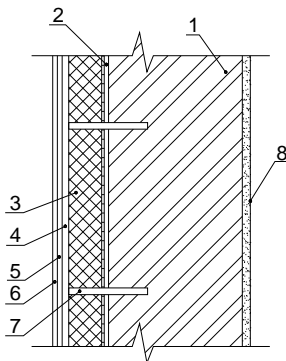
Система утепления фасадов с отделочным слоем из штукатурки 1 – силикатный кирпич; 2 – проникающая грунтовка клеевого состава; 3 – наружное утепление плитами из минераловатной плиты; 4 – армирующая сетка; 5 – кварцевая грунтовка; 6 – декоративный штукатурный слой; 7 – дюбель; 8 – штукатурка на цементно-песчаном растворе
